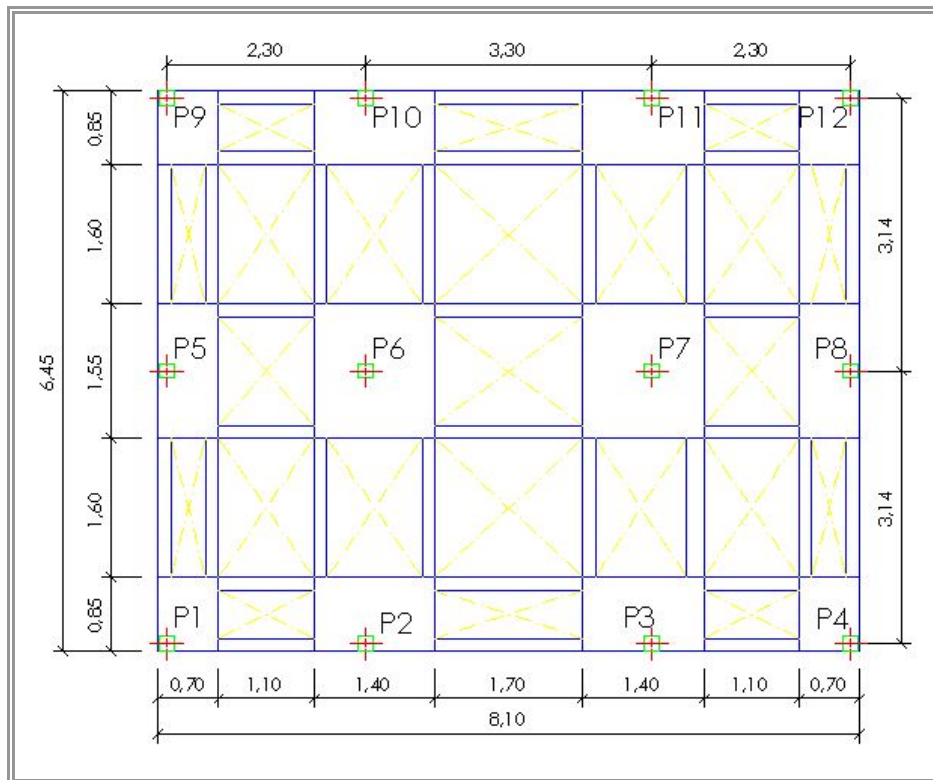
Esquema en planta de la cimentación estudiada. 8,10 x 6,45
